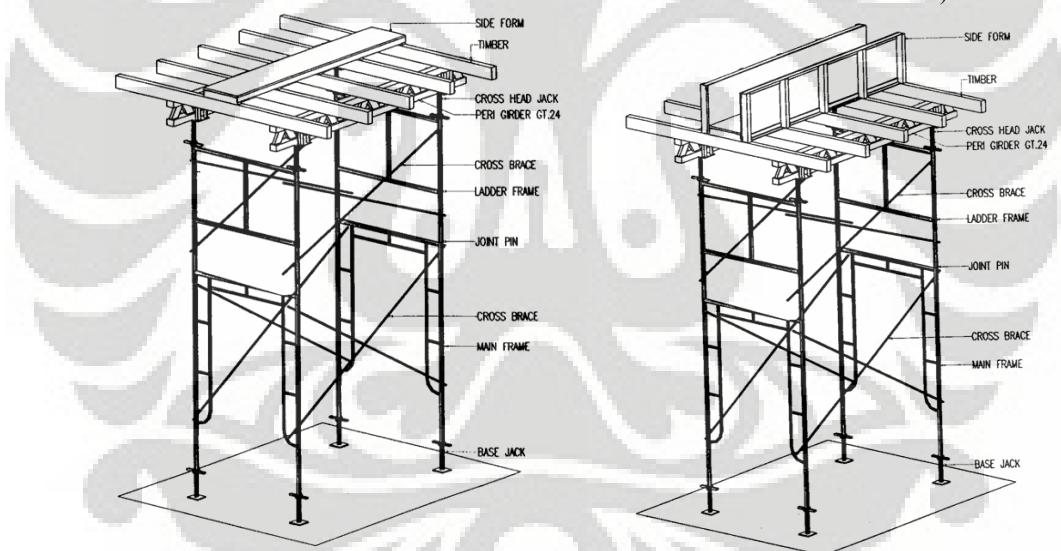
Urutan pemasangan scaffolding bagian atas dilanjutkan pasang girder GT 24
